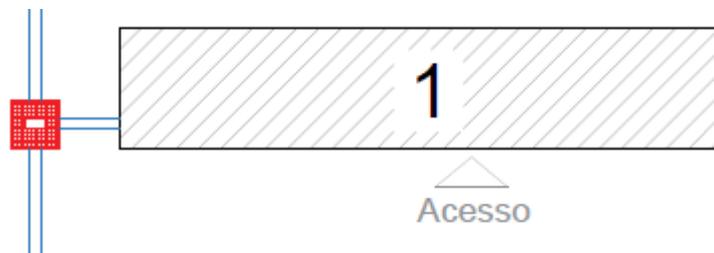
Detalhe em planta do ramal de distribuição de água.
